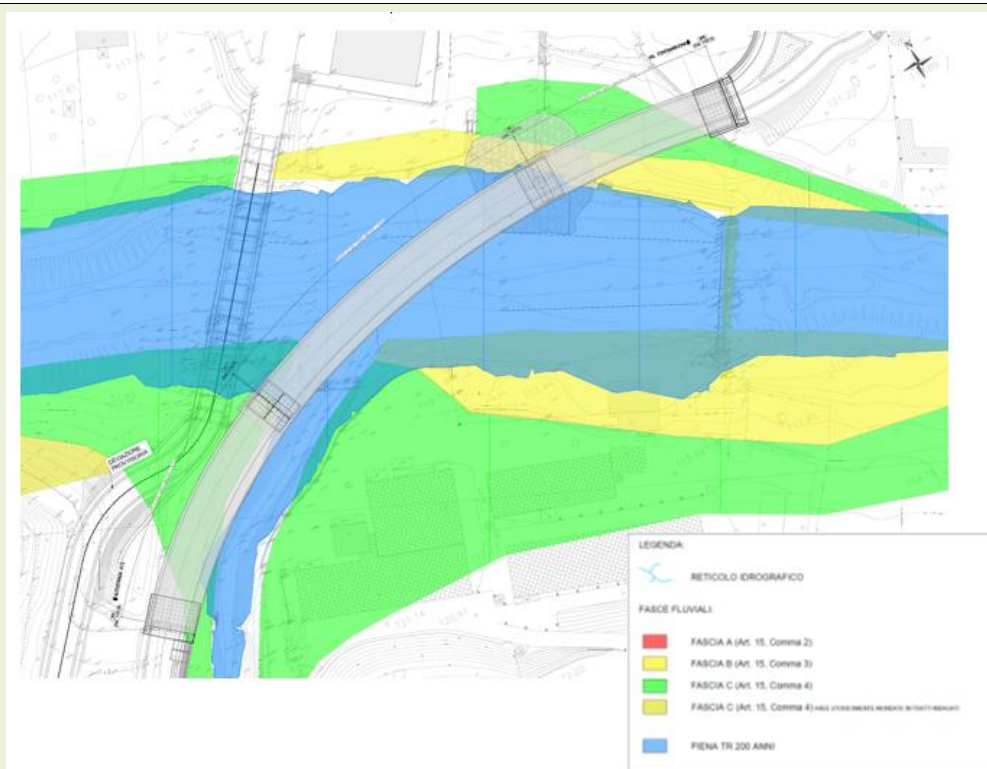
Planimetria viadotto Lavagna con sovrapposizione fasce d'inondabilità
